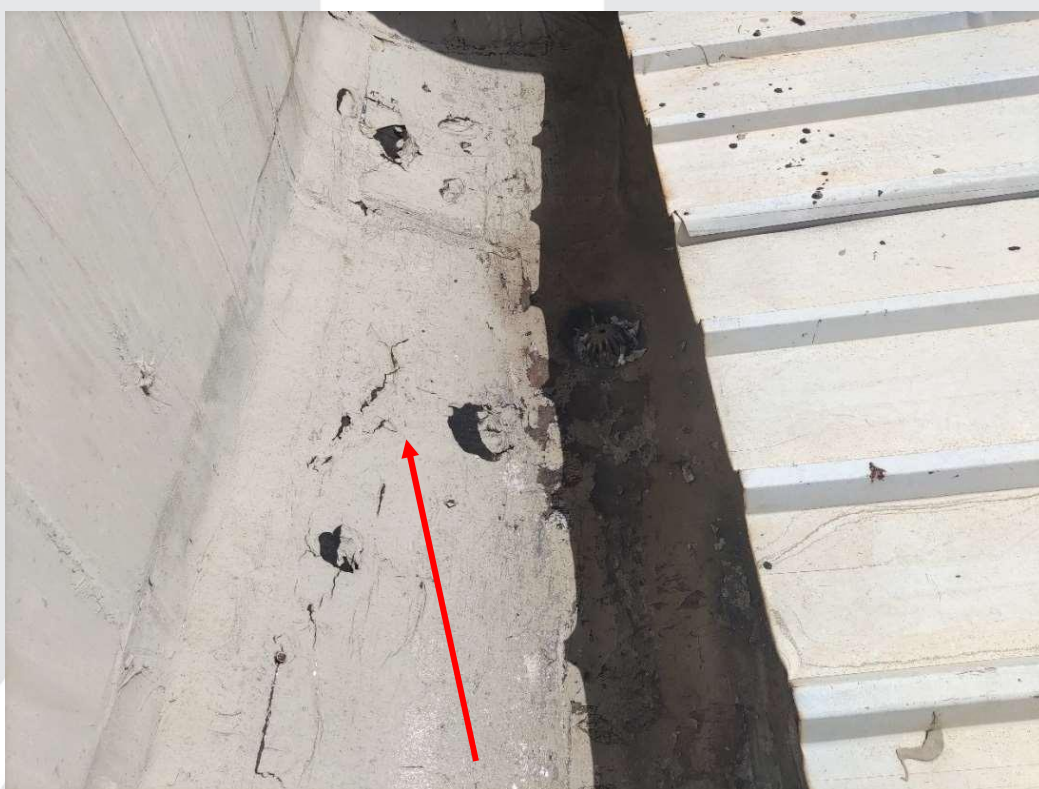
Sistema de impermeabilização em estado avançado de degradação
